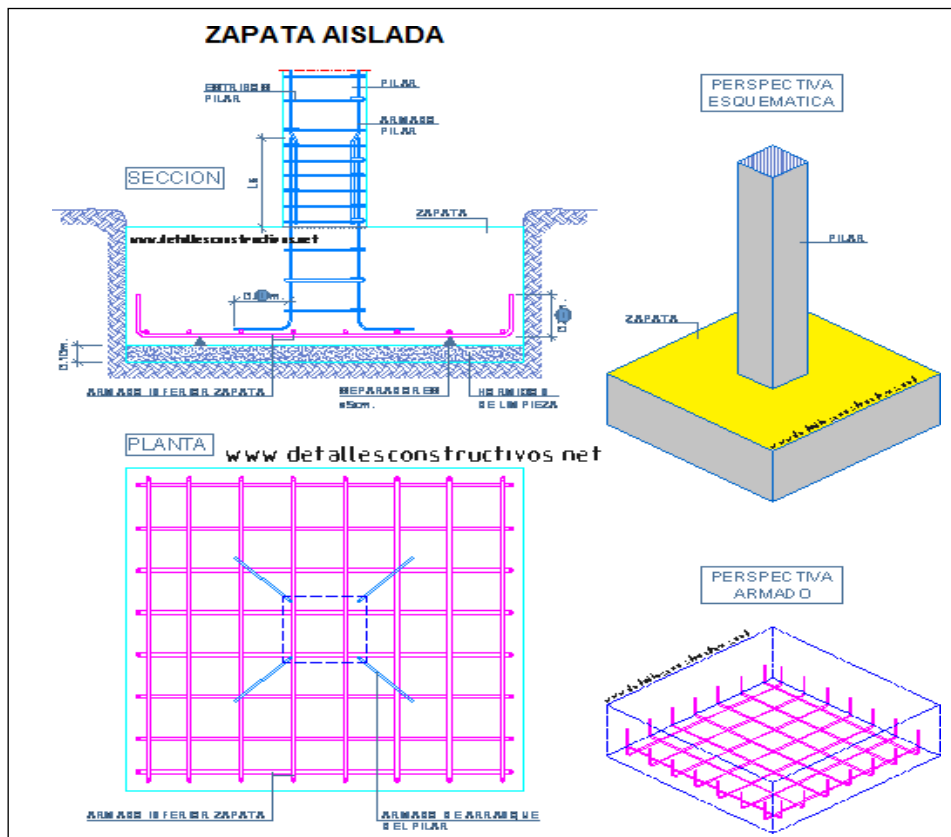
Zapata aislada. Fuente: Detalles constructivos.net
